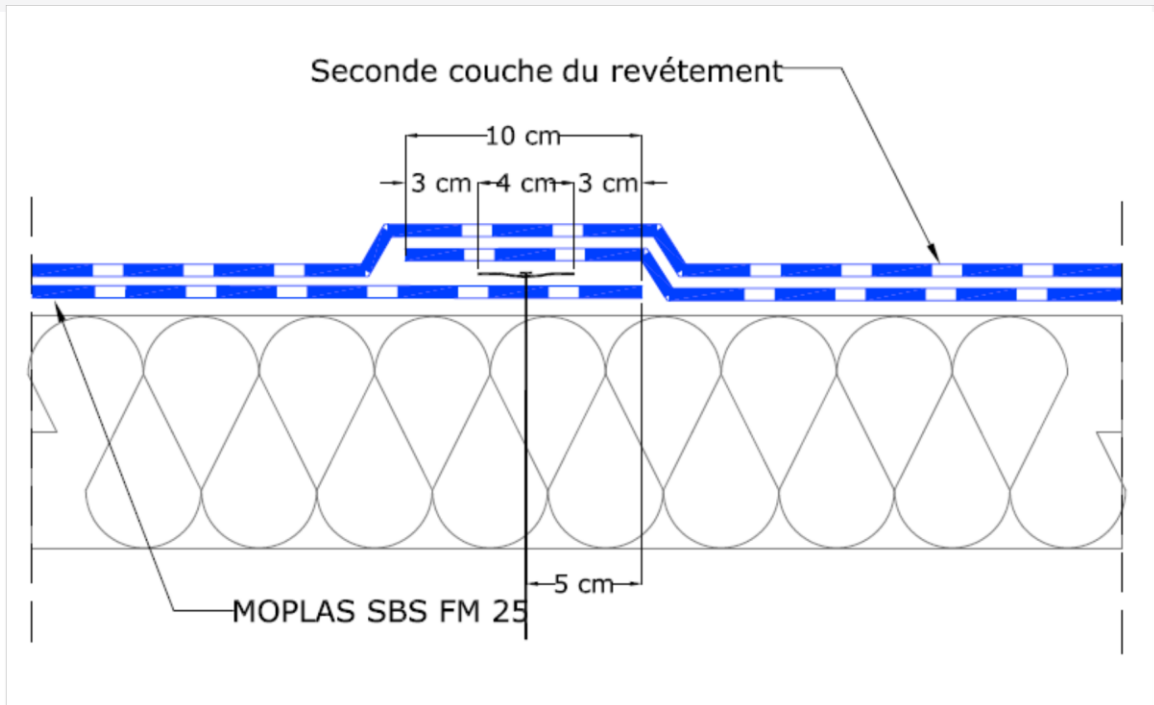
Coupe sur jonction et fixation en lisière de la 1re couche MOPLAS SBS FM 25
